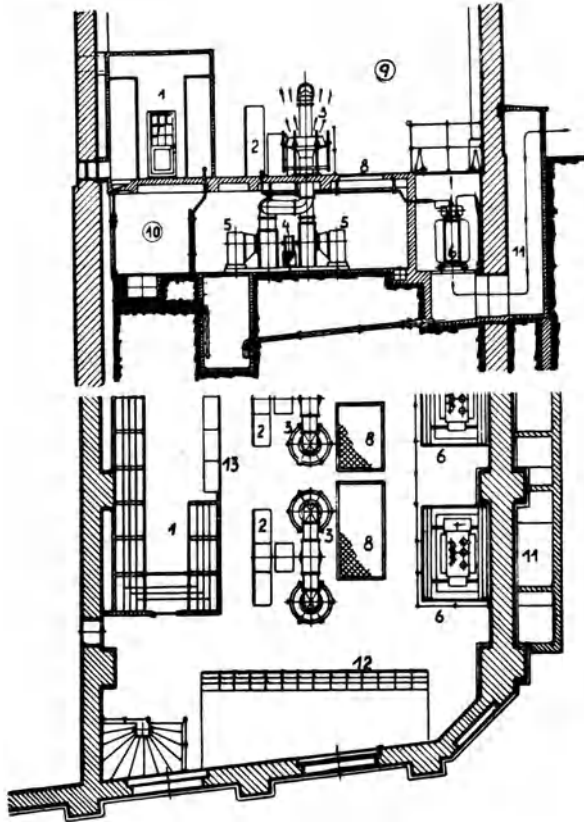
Grundriß und Aufriß einer Gleichrichterstation (ELIN.)
